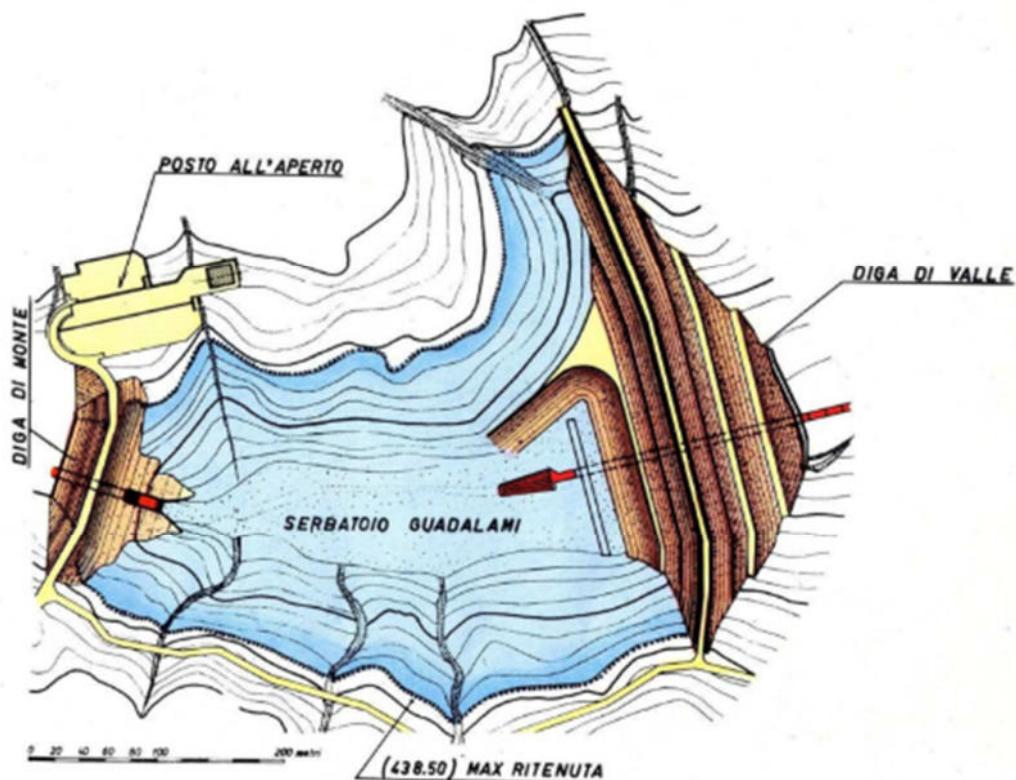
Planimetria del serbatoio di Guadalami (ENEL, 2013)
